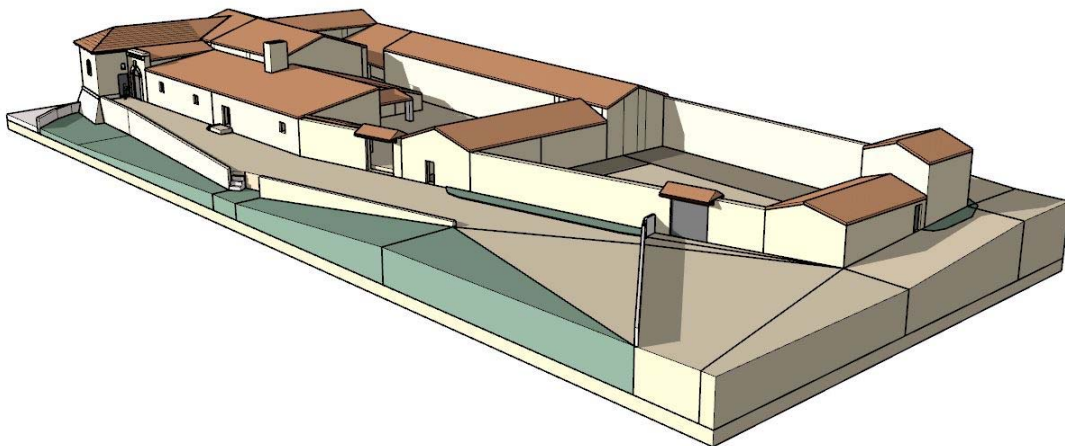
de la reconstrucción de las zonas tradicionales del conjunto de la Casa del Molinero desde el sureste. Observar que la maqueta no contiene el volumen de las construcciones aparentemente más recientes en el entorno del patio junto al palomar al este. Fuente: Elaboración propia
